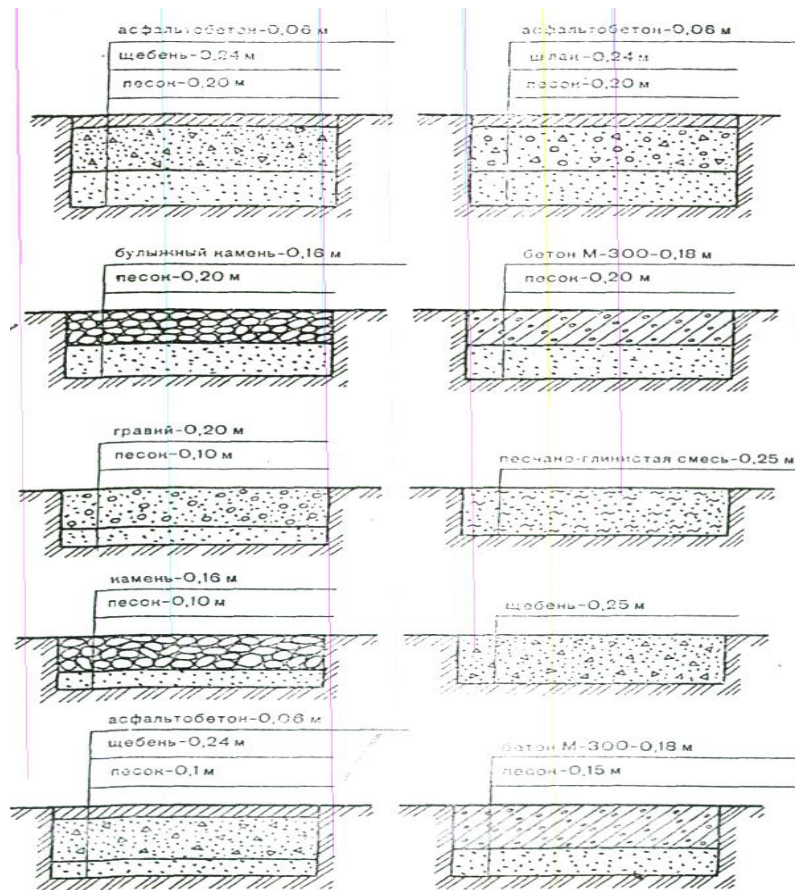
Схемы покрытий площадок для хранения техники
